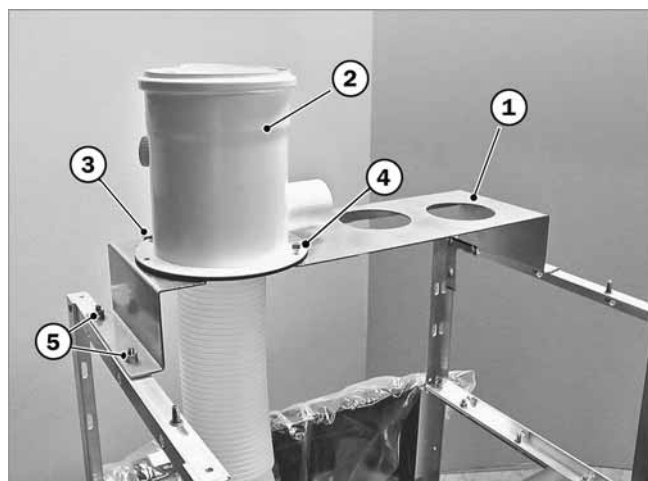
Konsolenblech und Abgasverrohrung montieren
